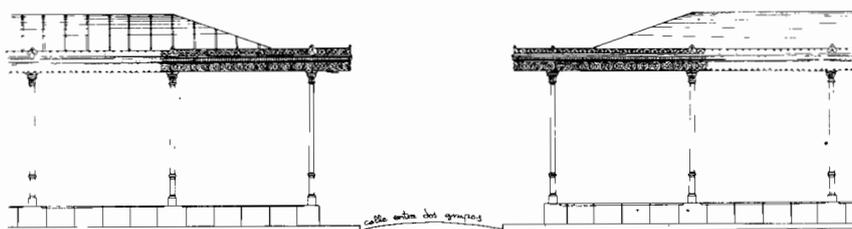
Proyecto de mercado de Juan Morán Lavandera. Firmado en Avilés a 12 de agosto de 1880. Alzado (según E. Toral).
